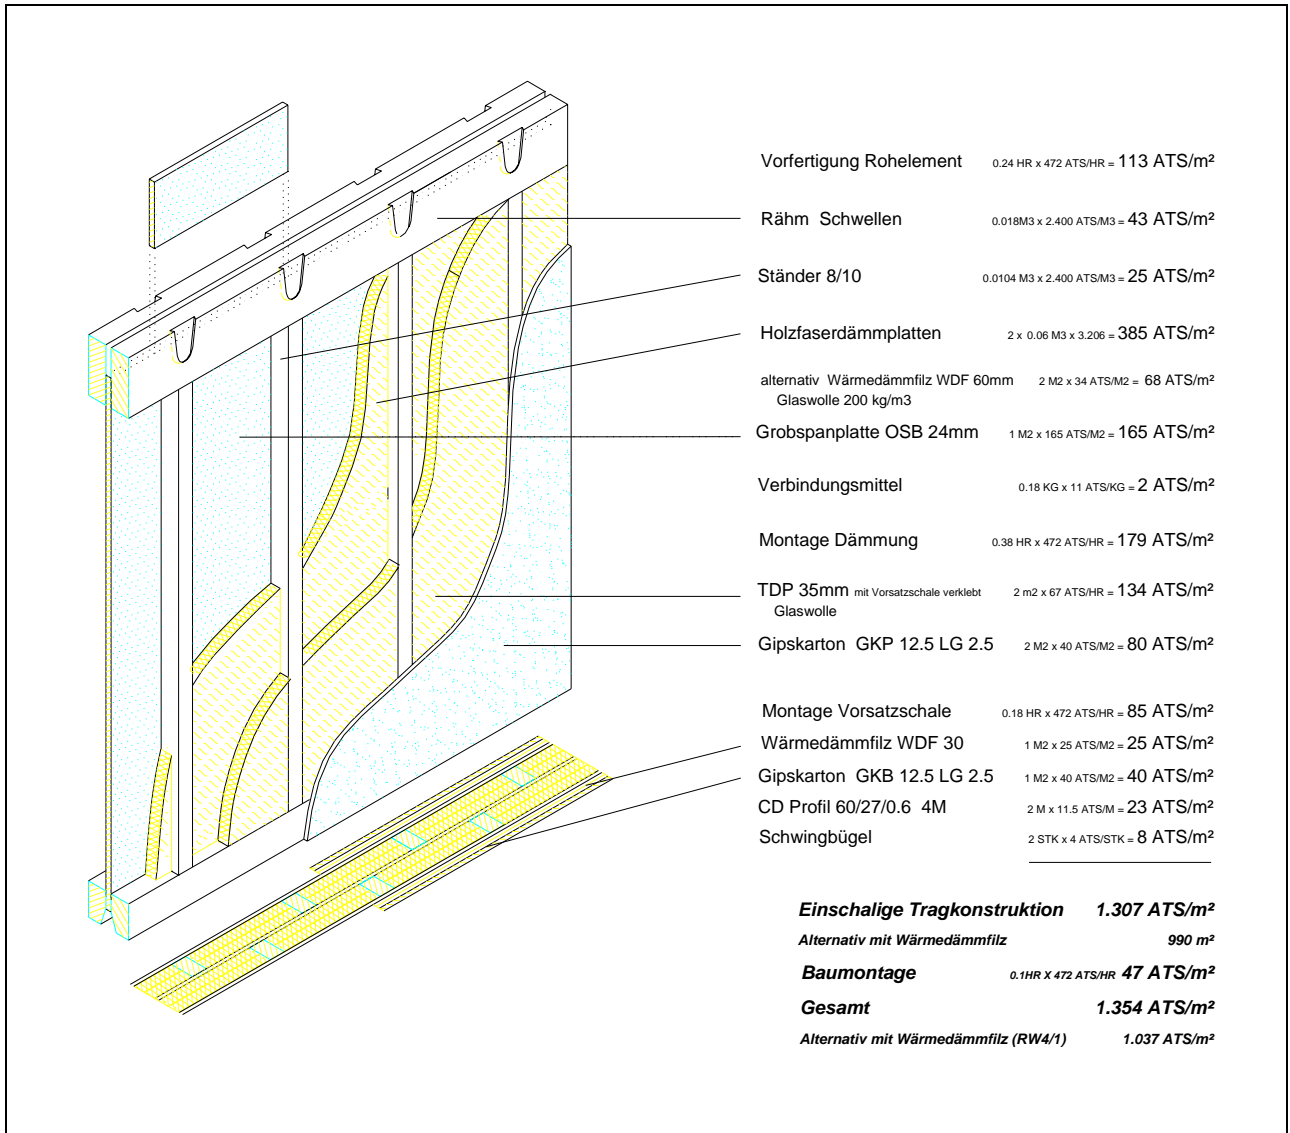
Einschalige Holzrahmenwand mit mittiger Scheibe (RW4)
